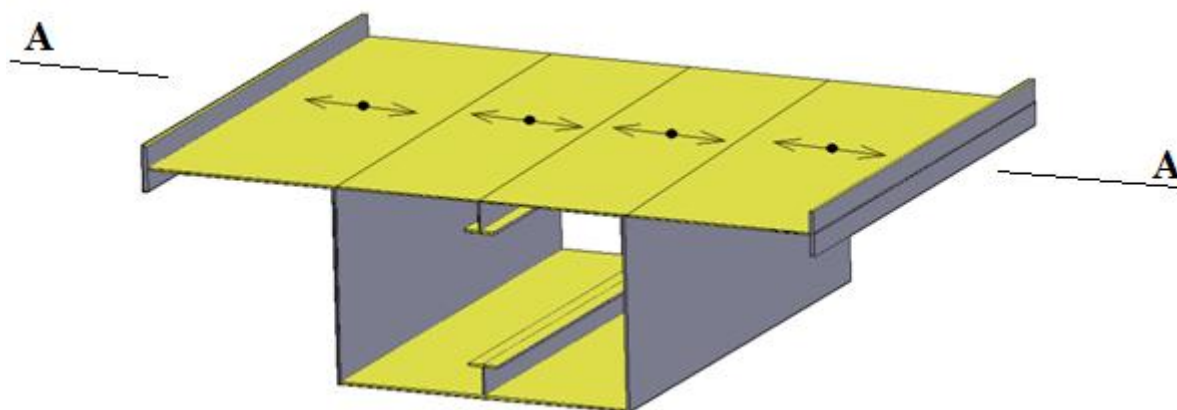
Distribuição das cargas verticais, aplicadas ao nível do pavimento, para os reforços longitudinais do banzo superior e as almas da secção.
